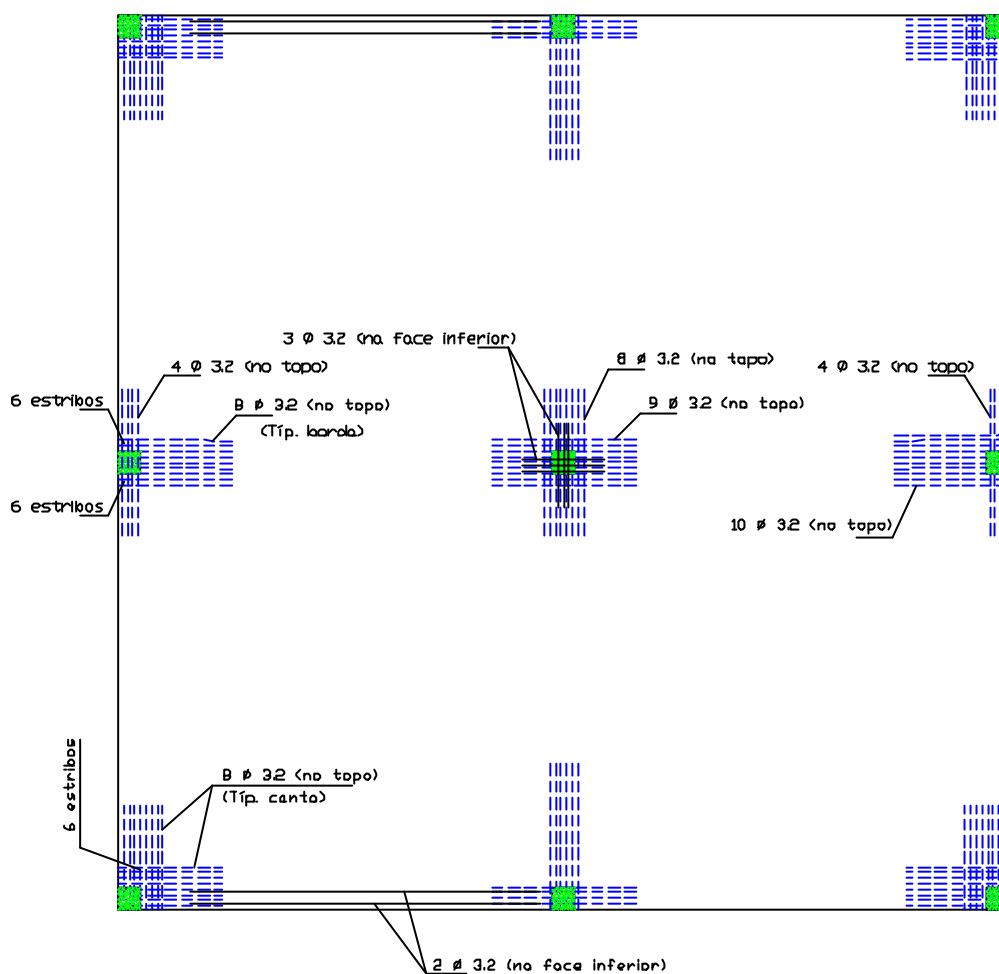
Armadura Aderente da Laje III –1976
